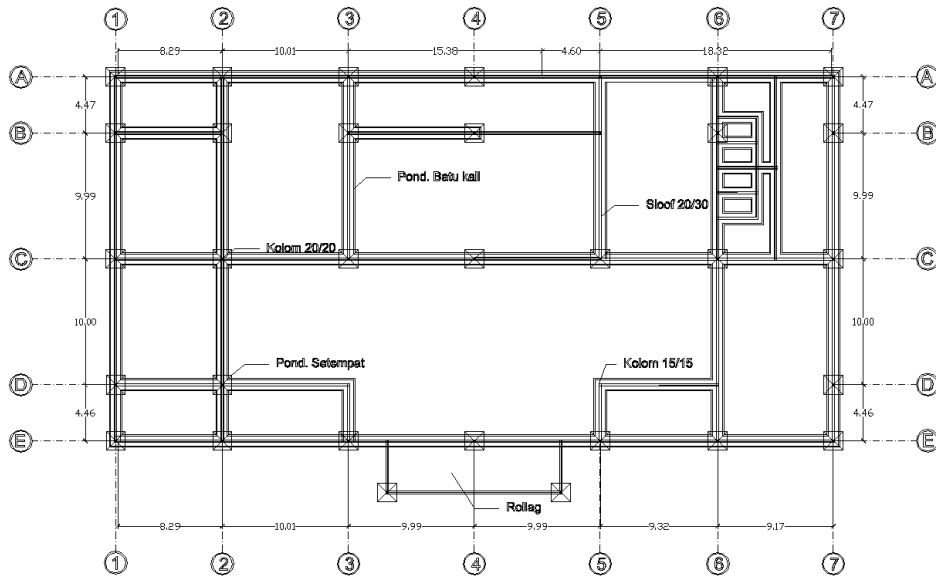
Rencana Pondasi Kantor Pengelola TPI
